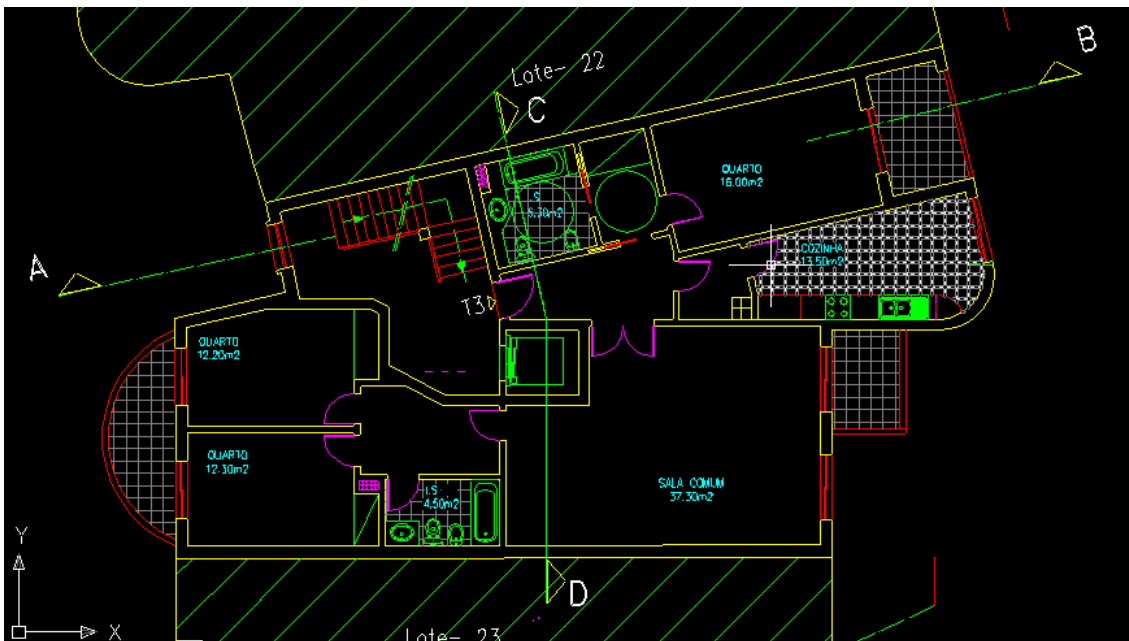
Planta do Piso 2 e 3 (Nova Faceta)
